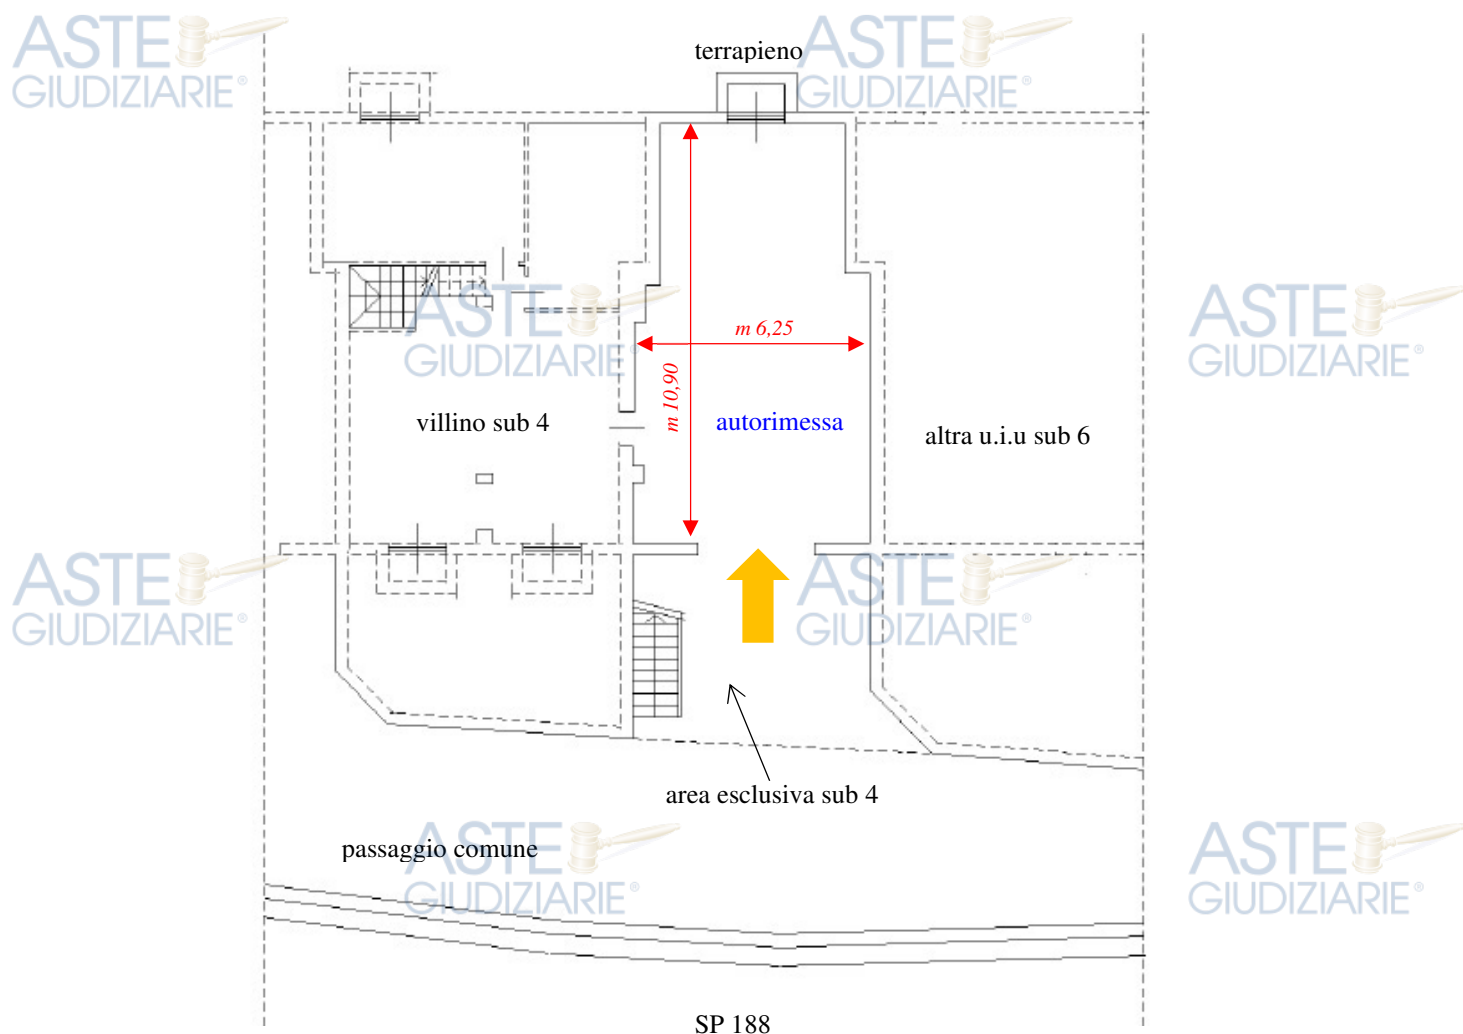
Planimetria non in scala dell'autorimessa sub. 5 (anche All. n. 7)
